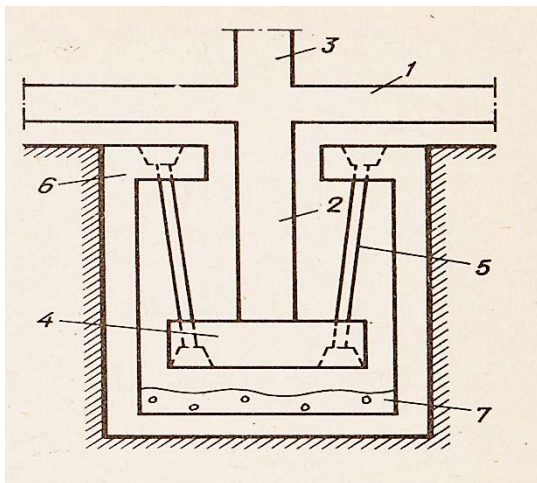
Сейсмоизолирующий фундамент с подвесными опорами:
